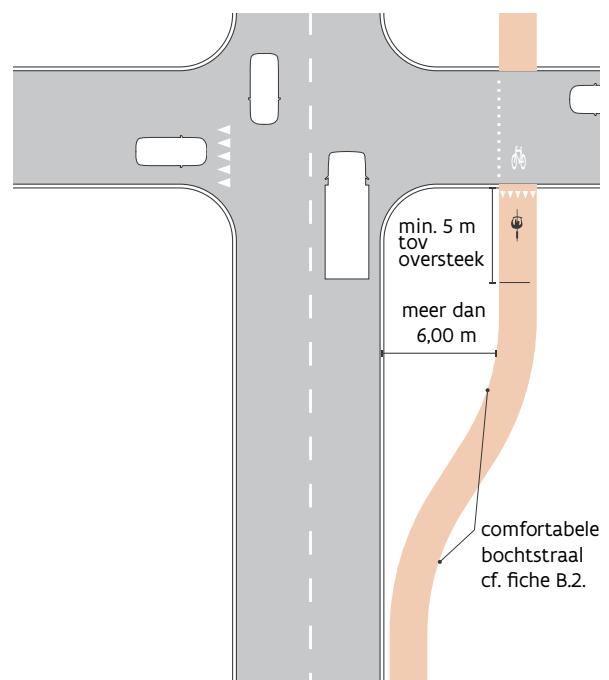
Uitgebogen fietspad (meer dan 6m) uit de voorrang
